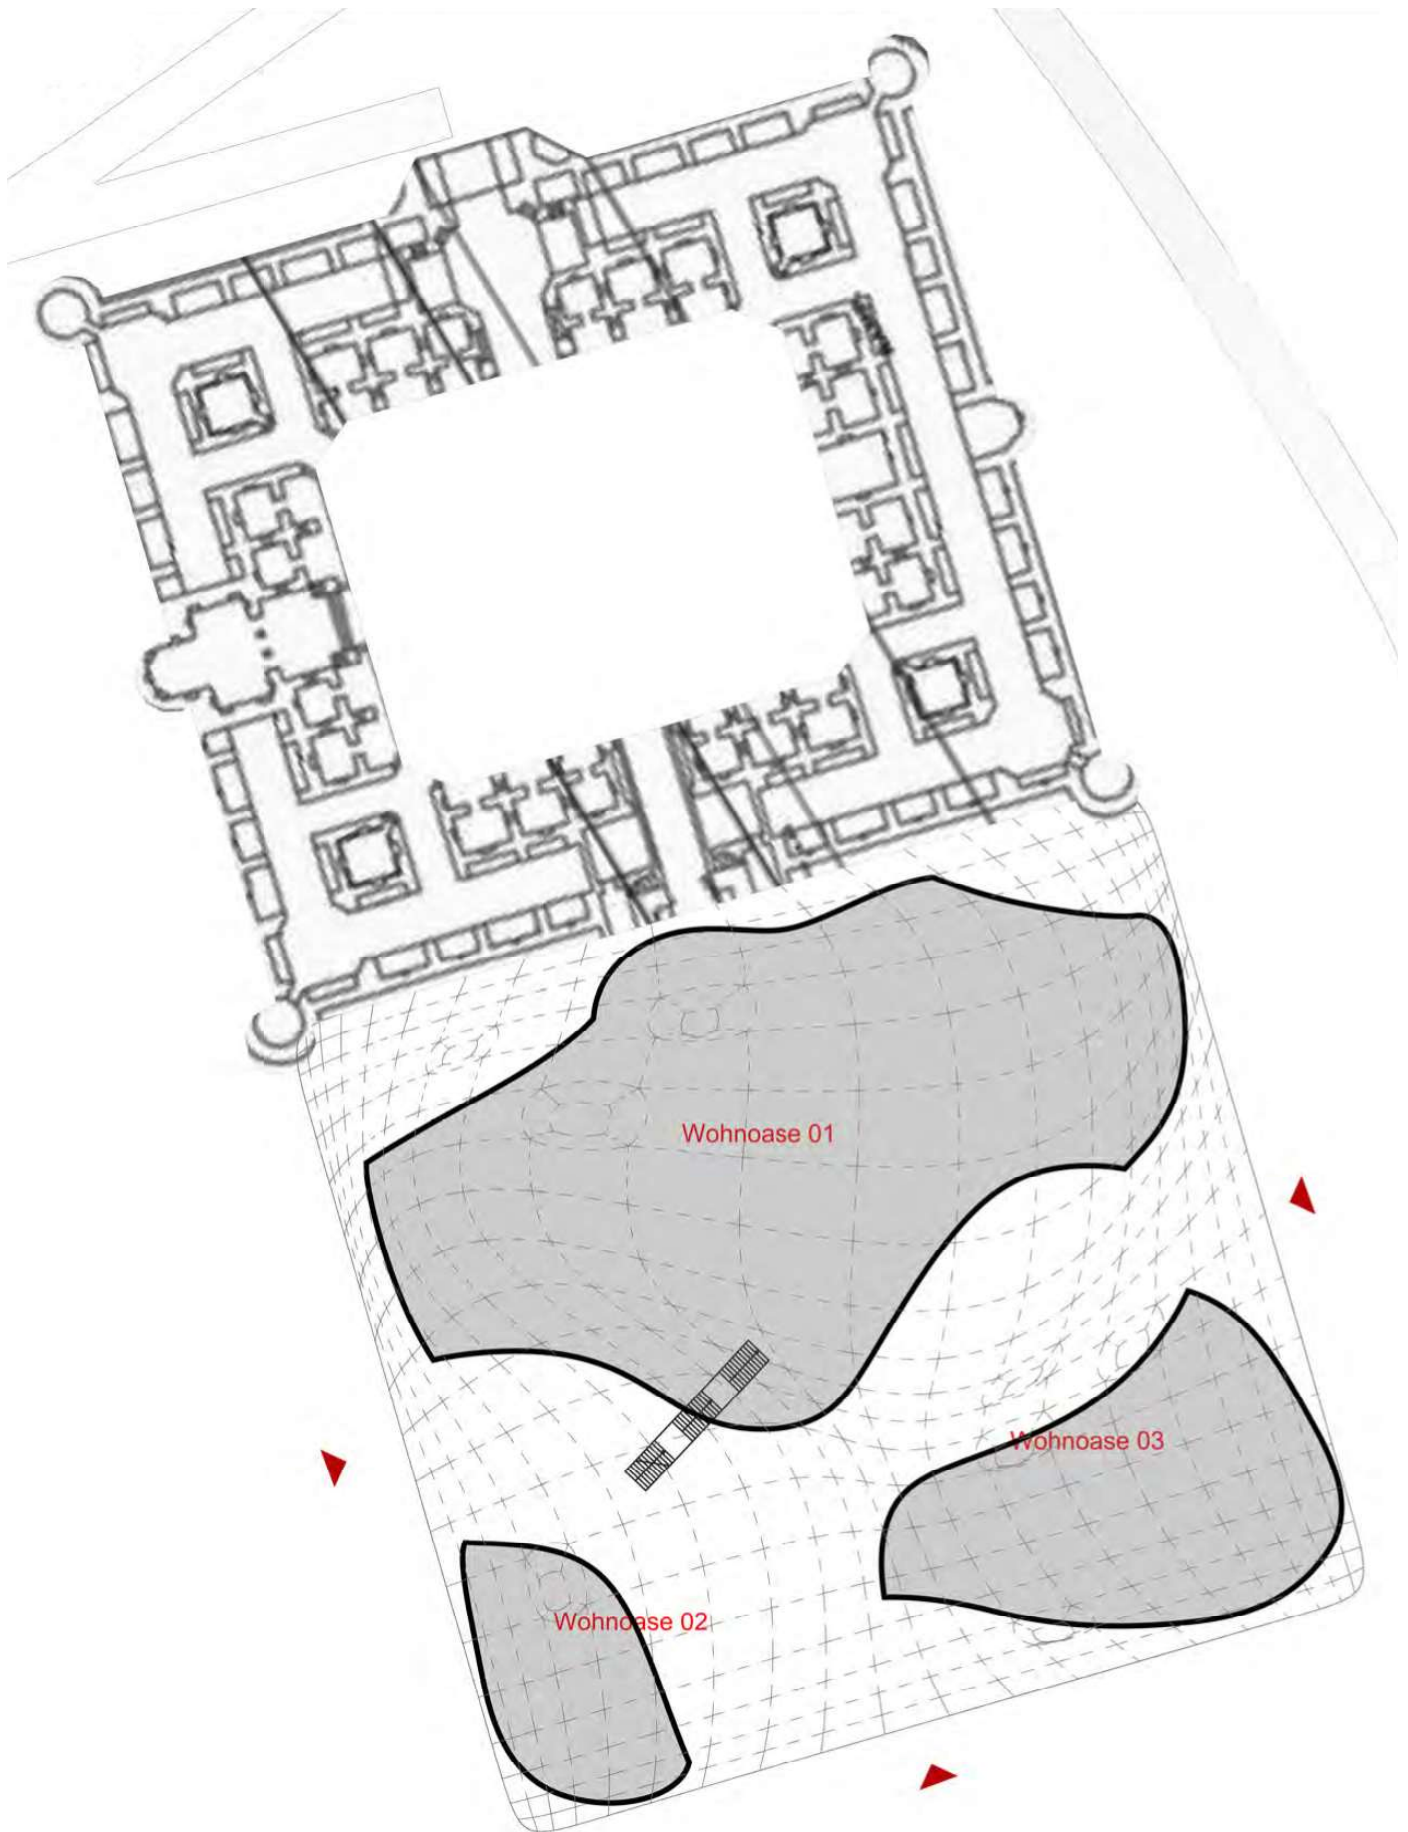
Formfindung, 1.Obergeschoss, Grundrisskonzept
